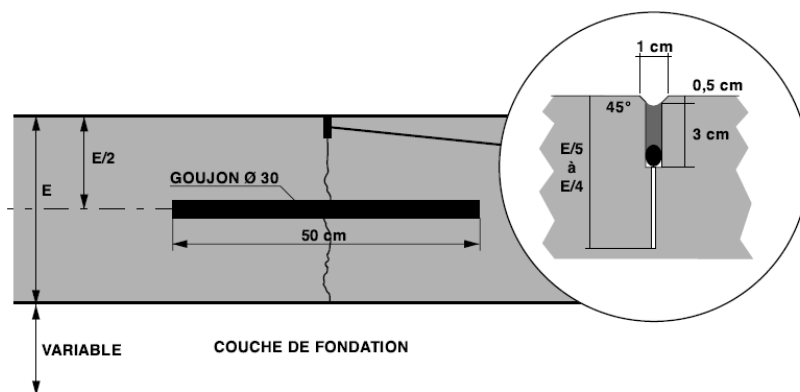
Dalles goujonnées – coupe longitudinale au niveau d'un joint de retrait
